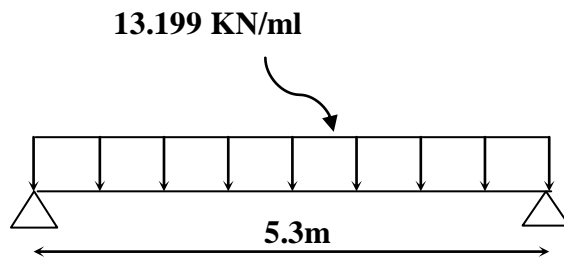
Schéma statique de la poutre de chaînage à l'ELU.
